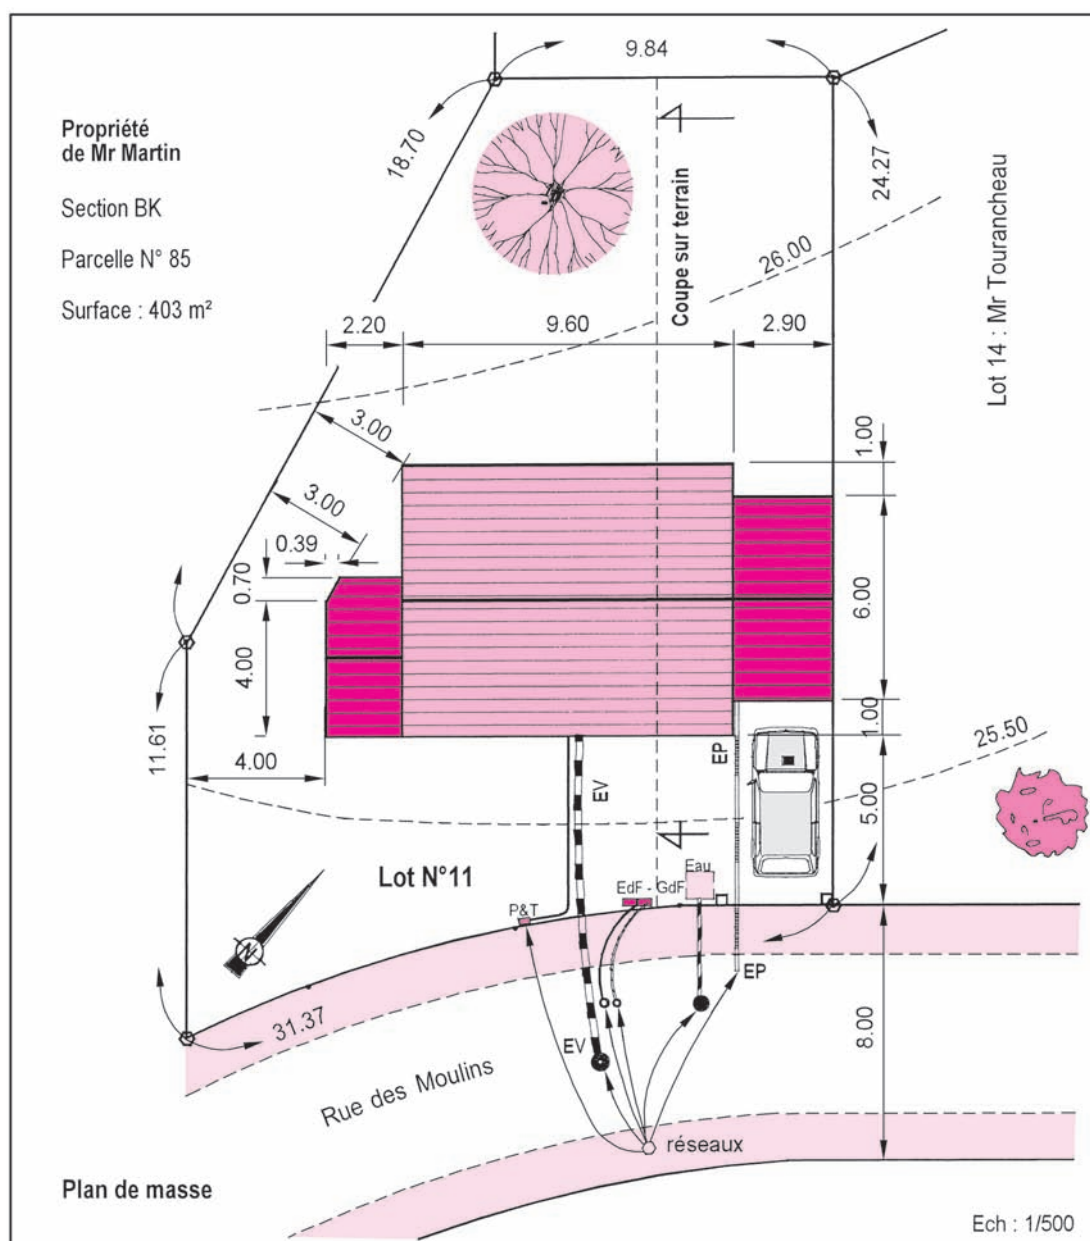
Plan de masse avec les cotes pour l'implantation
